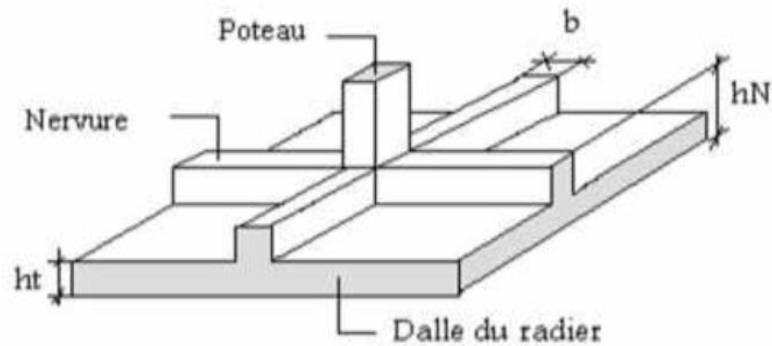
Disposition des nervures par rapport au radier et aux poteaux.
